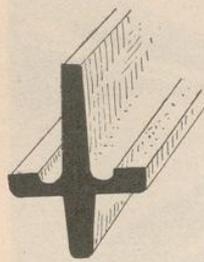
Dachdeckung. Glasdach. \pm -förmiges Sprosseneisen ohne Rinne für das Schweißwasser.
